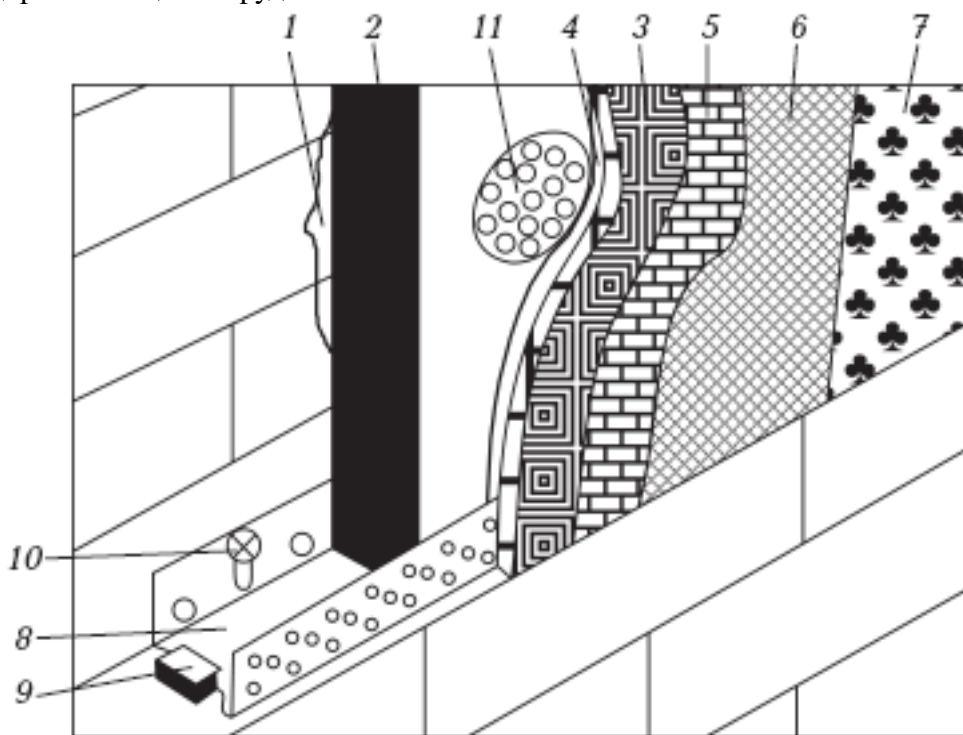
Система внешней теплоизоляции «мокрый фасад»: 1 – клеящий раствор; 2 – теплоизоляционная плита; 3 – армированный раствор; 4 – сетка из стекловолокна; 5 – грунтовка; 6 – минеральная штукатурка; 7 – фасадная краска; 8 – цокольная планка; 9 – соединительный элемент цокольной планки; 10 – крепления цокольной планки; 11 – тарельчатый дюбель
